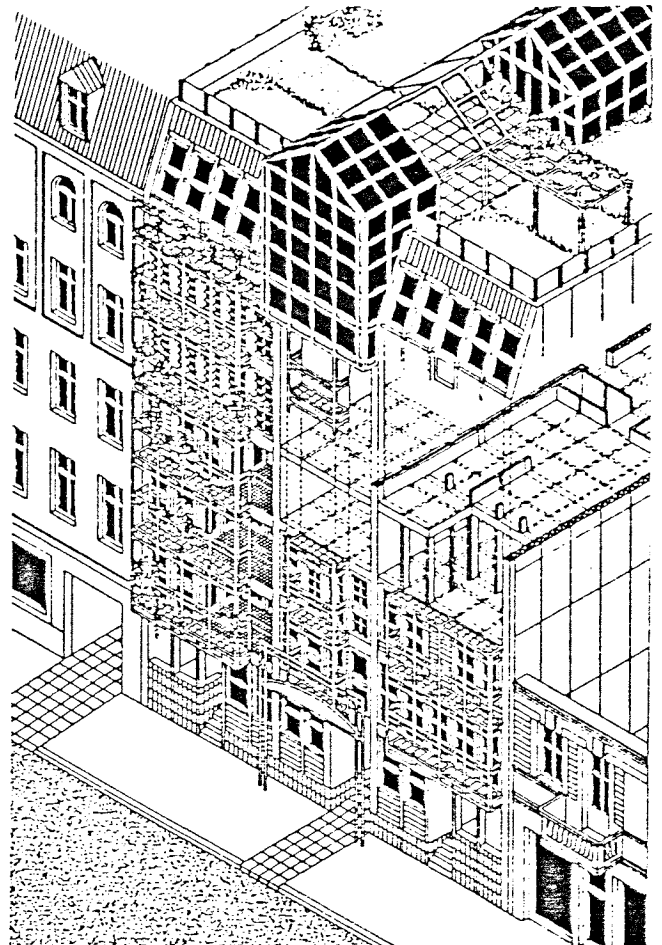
Fassadenisometrie mit begehbarem Rankgerüst, begrünter Dachterrasse und den über zwei Geschosse reichenden Raumhüllen.
